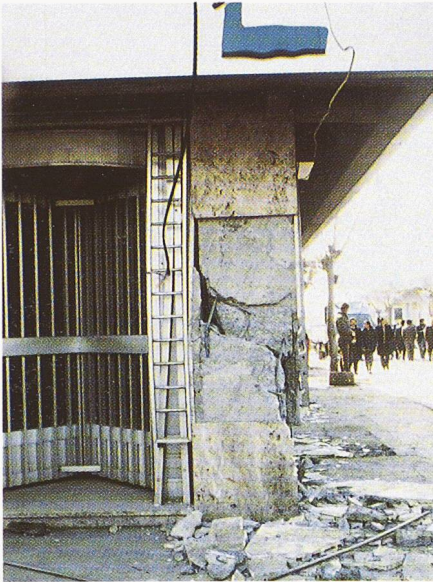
Schubbruch einer ungenügend bewehrten Randsütze eines dreigeschossigen Eckgebäudes
